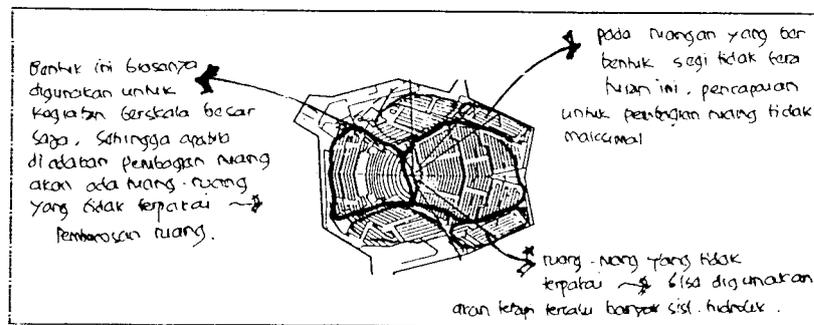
Analisa fleksibilitas (pembagian ruang) bentuk ruang kipas (fan shape).
